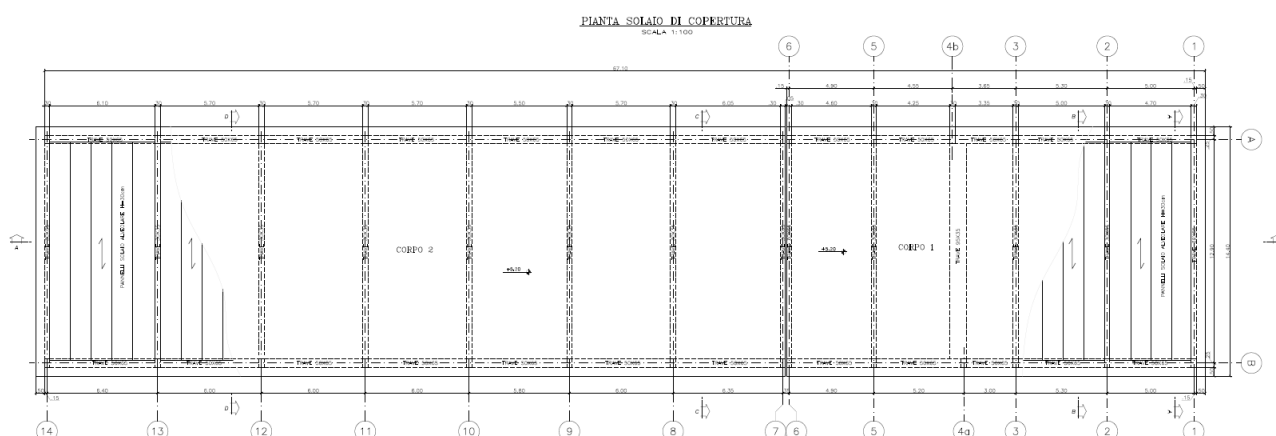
Pianta carpenteria solaio di copertura della sottostazione elettrica.
